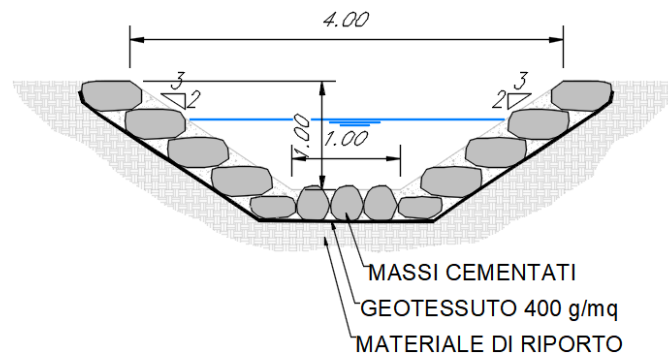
Corso d'acqua IN08_Sezione tipo sistemazione
